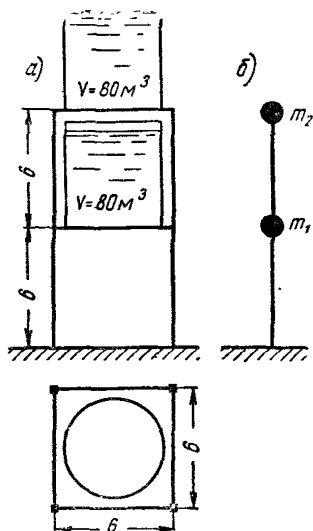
Расчетная схема двухэтажного рамного каркаса, на котором установлены резервуары с жидкостью
